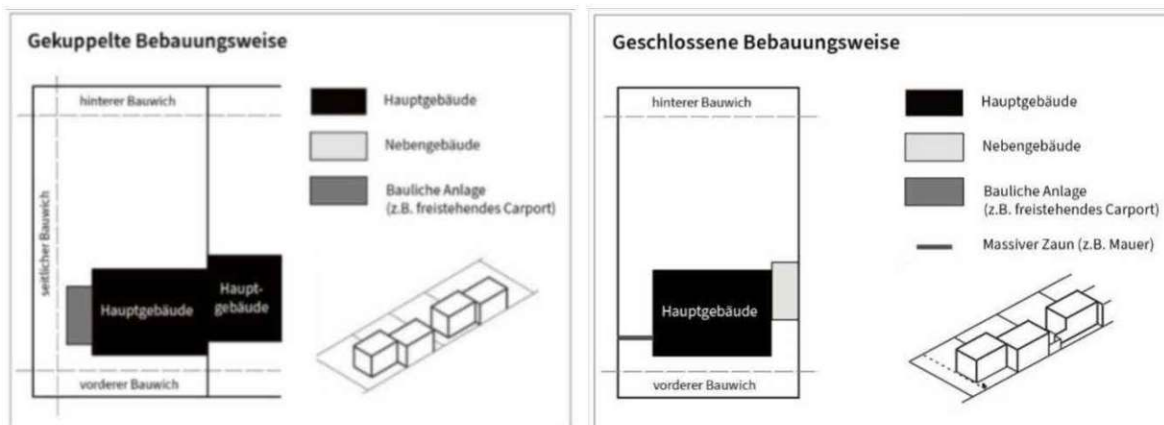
Bauungsweisen in Niederösterreich: gekuppelt und geschlossen,
